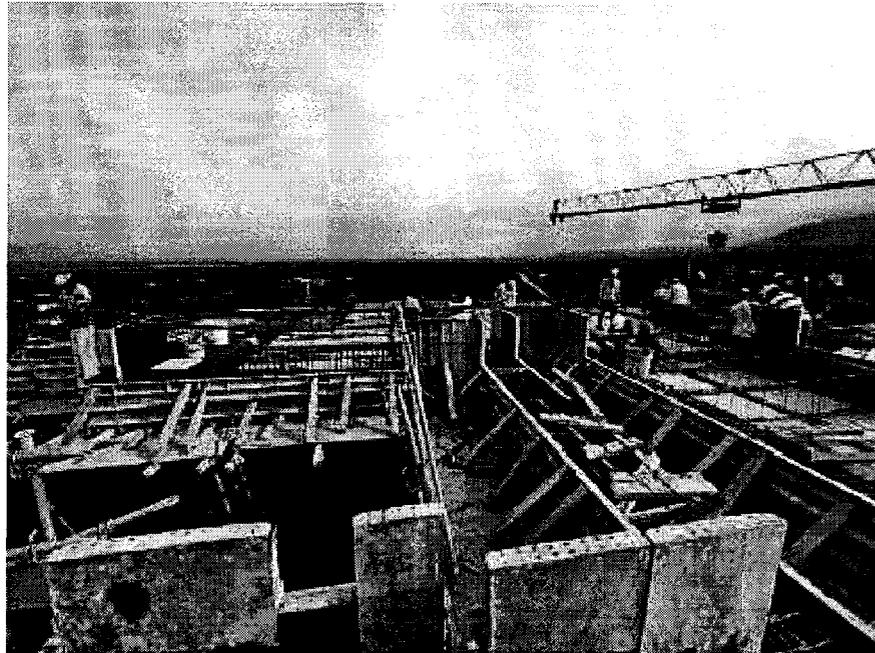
Avance armado y encofrado de losa cubierta, ejes (H-L y 6-8) – Torre B.
